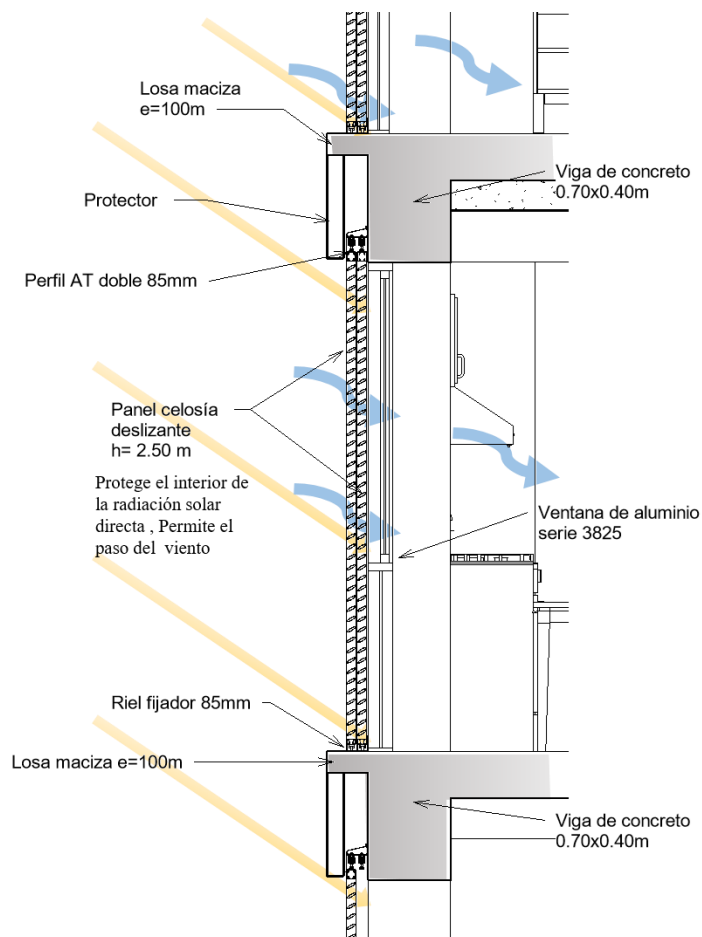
Esquema de celosía deslizante para viviendas en la fachada oeste y este.
